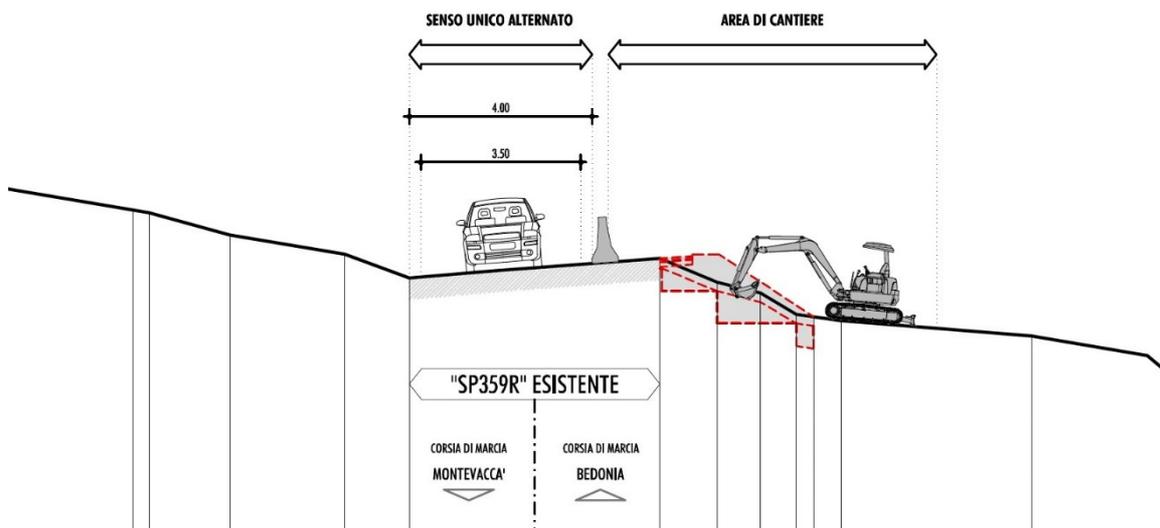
TRATTO 2, FASE 2: TRAFFICO SU CORSIA DI VALLE (ESTRATTO DALL'ELAB. PD.04.04)
